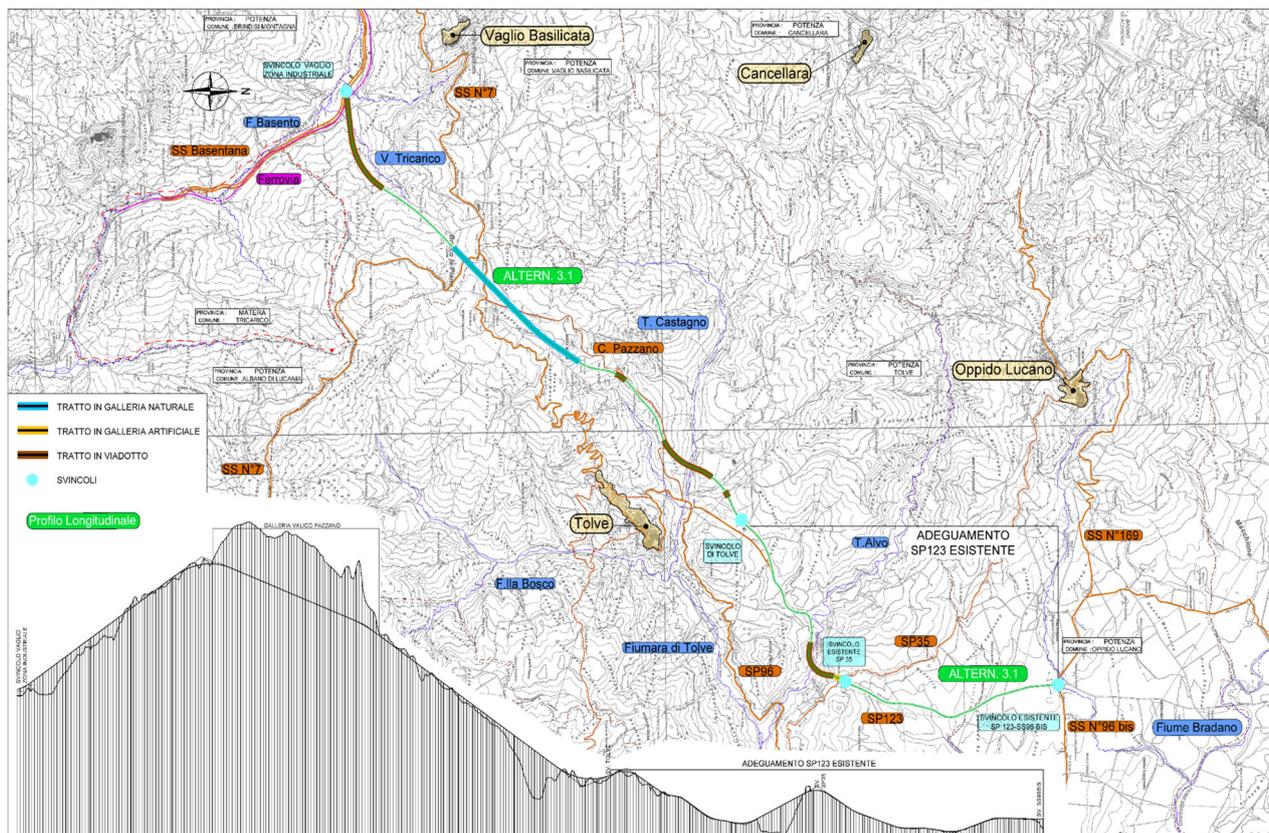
Tracciato dell'Alternativa di Progetto e rete stradale esistente
